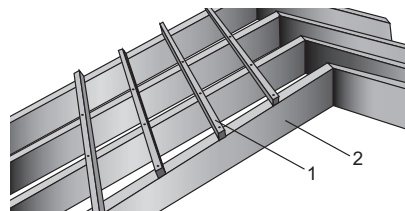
Крепление обрешетки к фермам: 1 — стропильная ферма; 2 — обрешетка
